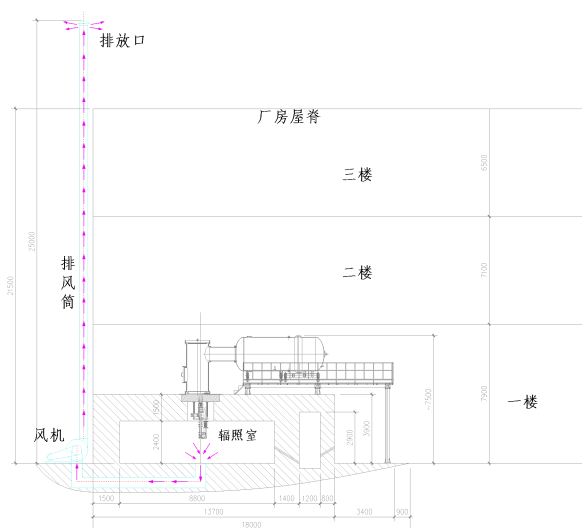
本项目加速器机房通风管道布设示意图（剖面图）
